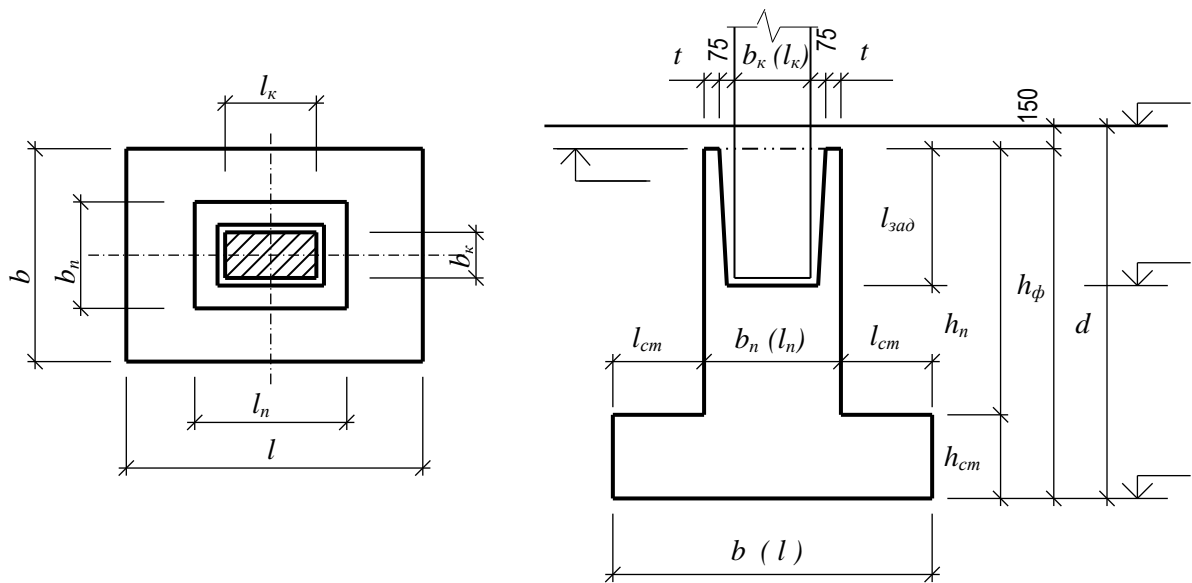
До конструювання окремого монолітного залізобетонного фундаменту під збірну залізобетонну колону.
